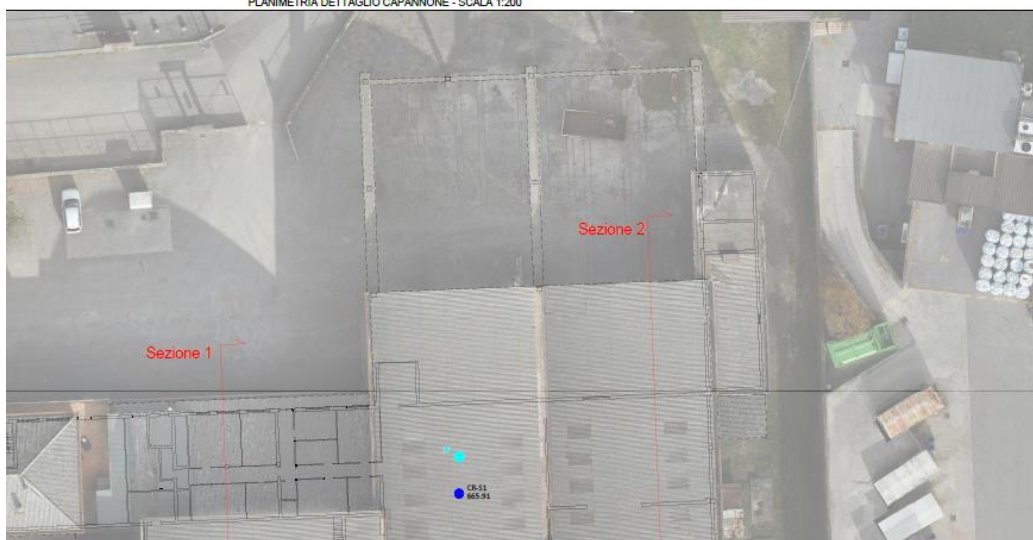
Estratto dalla Tavola 2a - Dettaglio capannone
